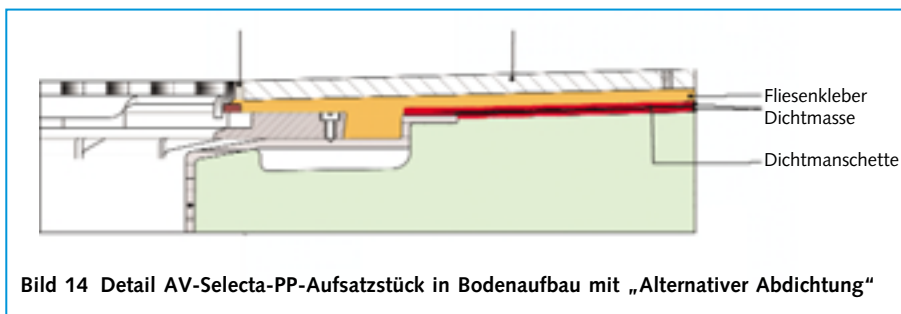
Detail AV-Selecta-PP-Aufsatzstück in Bodenaufbau mit „Alternativer Abdichtung“
